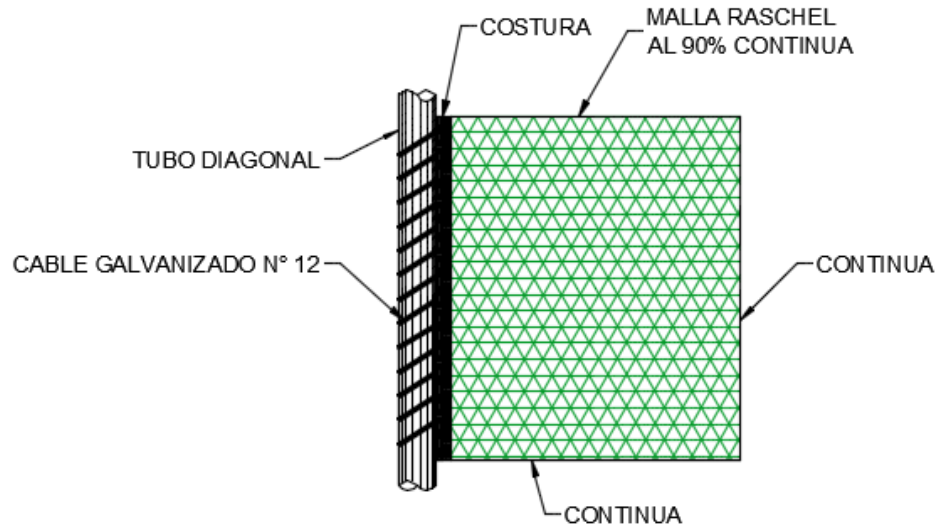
Detalle de enganche de la lona a los apoyos laterales. [Fuente: Elaboración propia]
